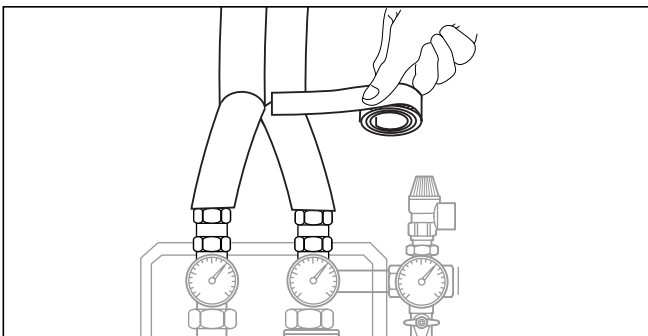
Rohrende mit Dämmschlauch isolieren. Dämmschlauch mit HT-Tape sichern.
